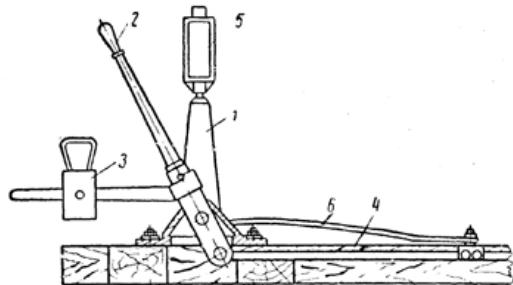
Конструкция переводного механизма (станка): 1 – станина; 2 – рычаг переводной; 3 – рычаг противовеса и противовес (баланс); 4 – переводная тяга; 5 – фонарь; 6 – подводка фонарной тяги
